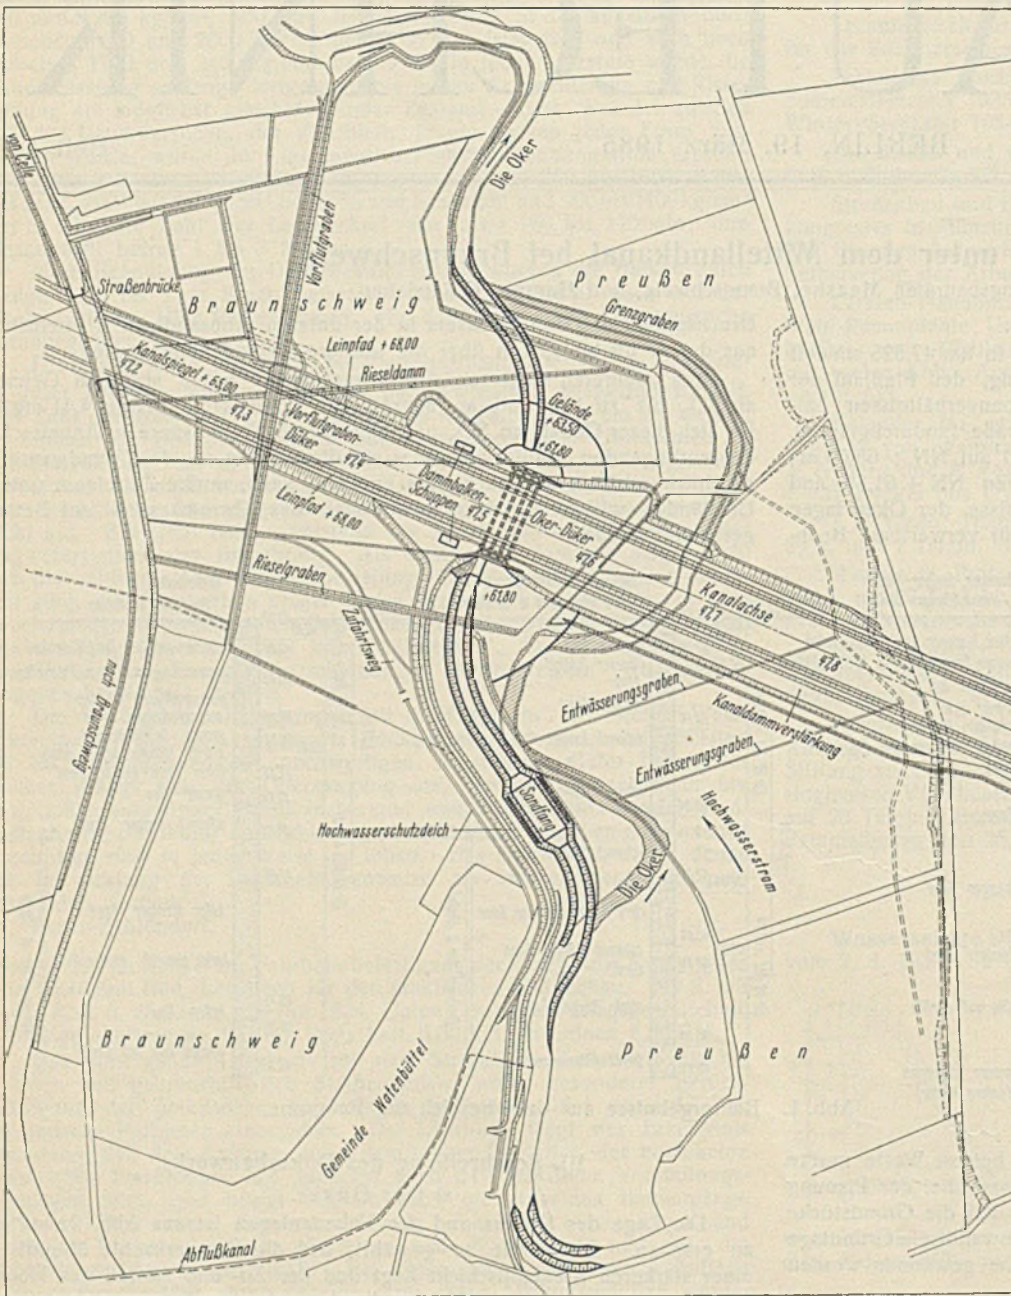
Übersichtslageplan des Dükers und der Nebenanlagen.
